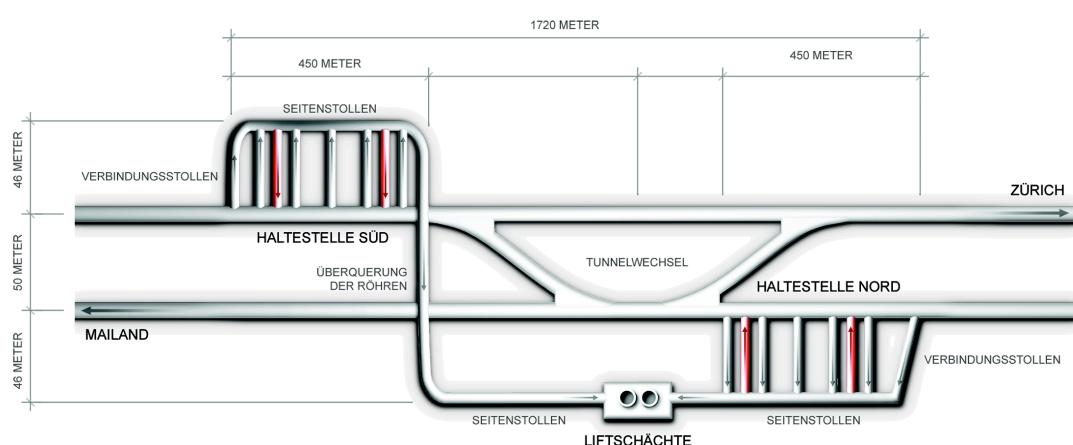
Grundriss Station Porta Alpina Sedrun
